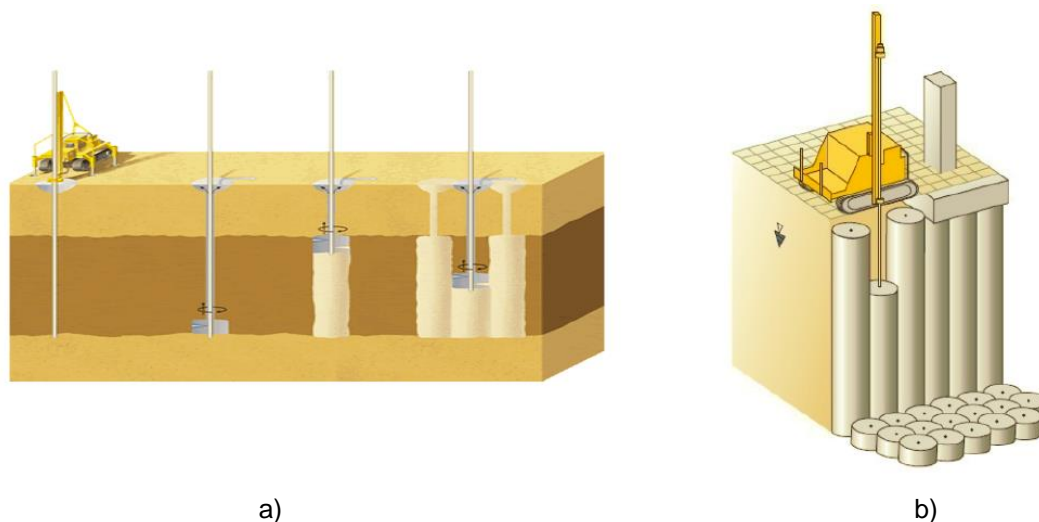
Aplicação da técnica de *jet grouting*: a) em colunas; b) em "lajes" (Dias Pereira, 2008)
